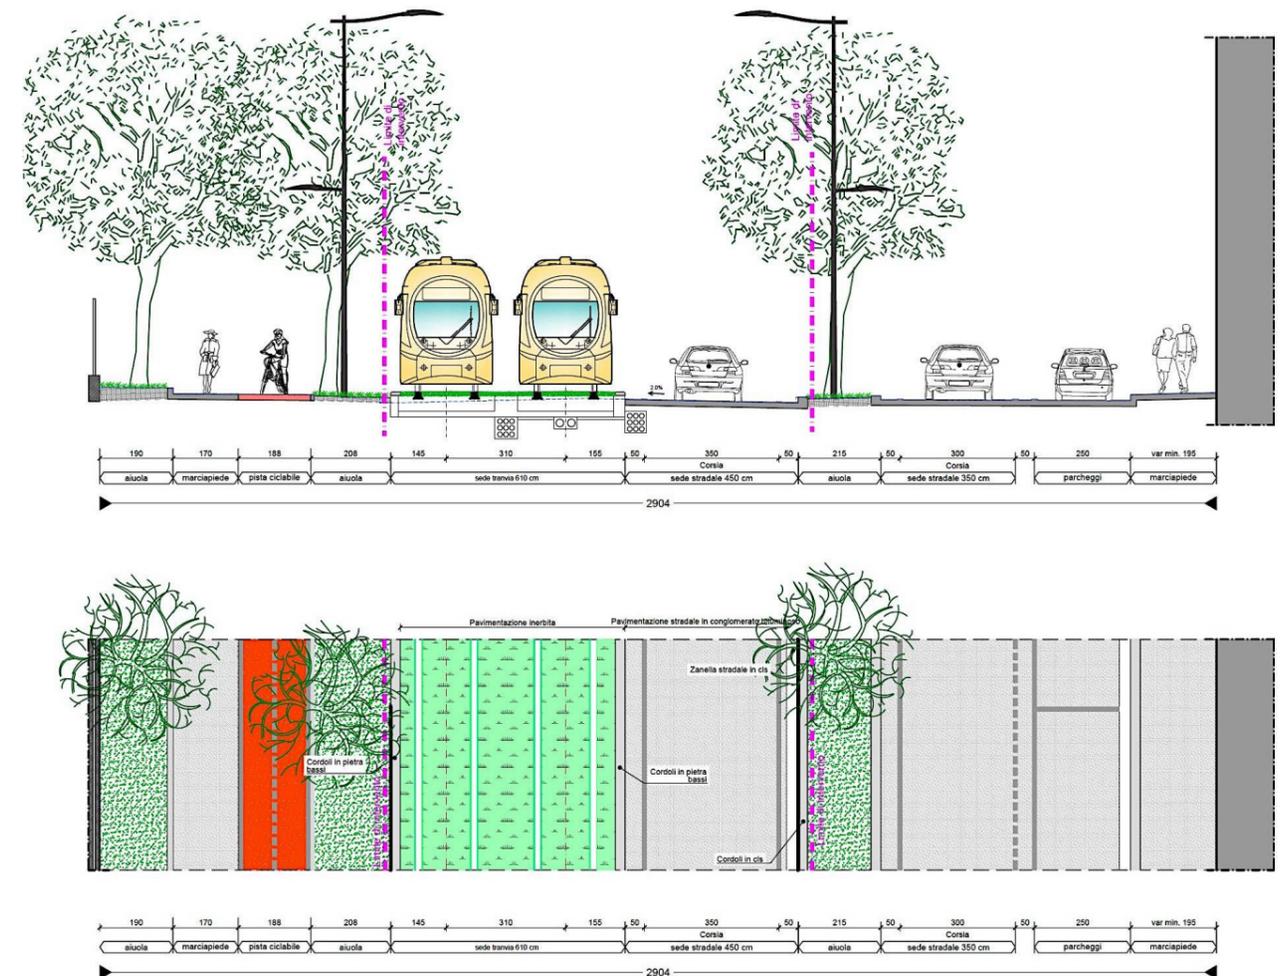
Sezione tipo viale Fanti Ovest-Progetto
